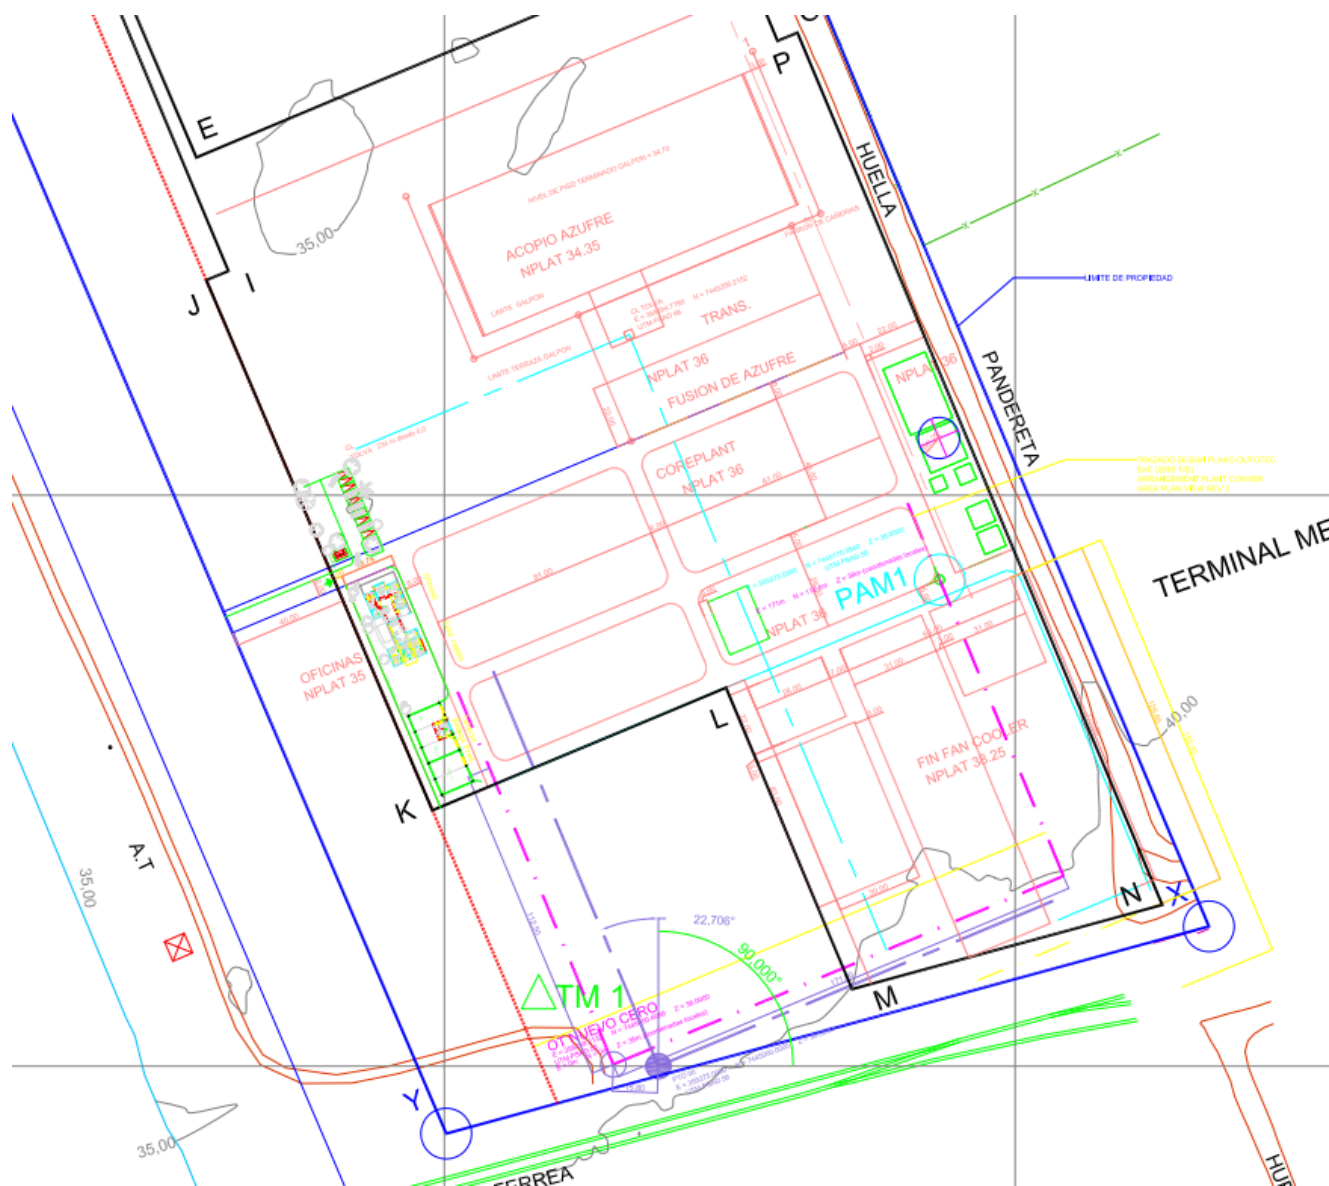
Layout del proyecto (Fuente: Anexo 1 Adenda 1 Proyecto Ampliación Planta de Ácido Sulfúrico Mejillones).
